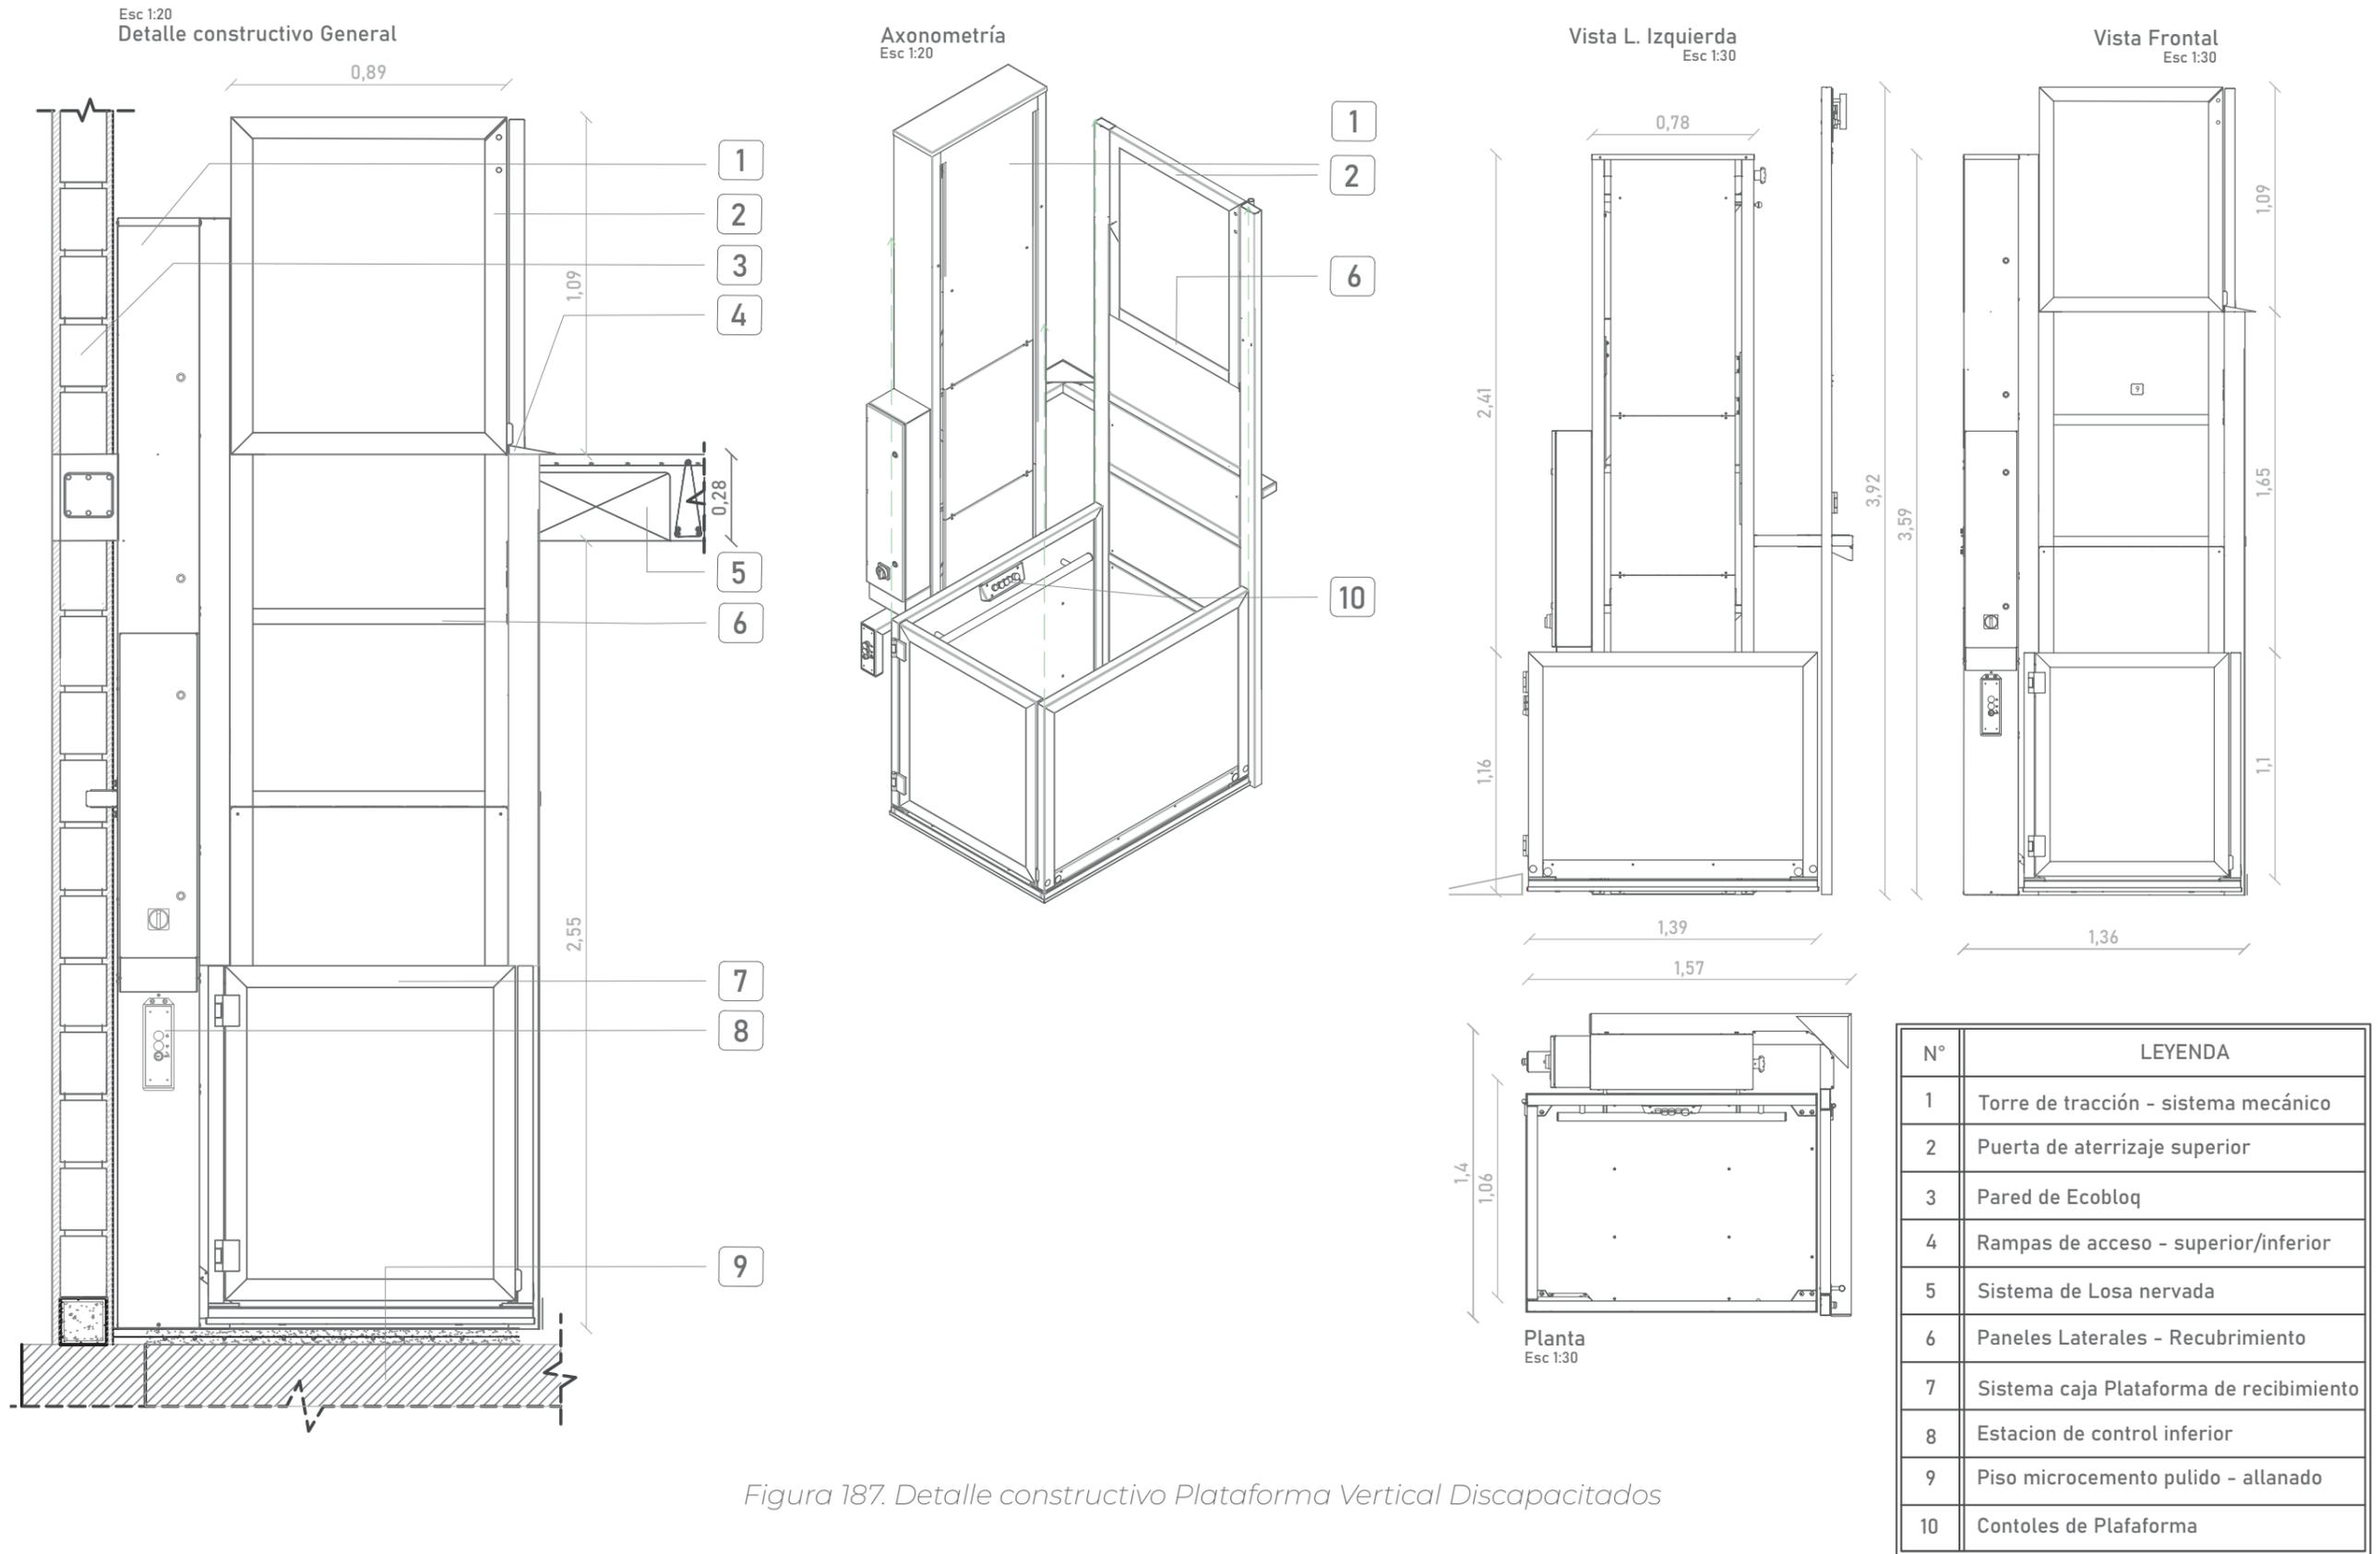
Detalle constructivo Plataforma Vertical Discapacitados
